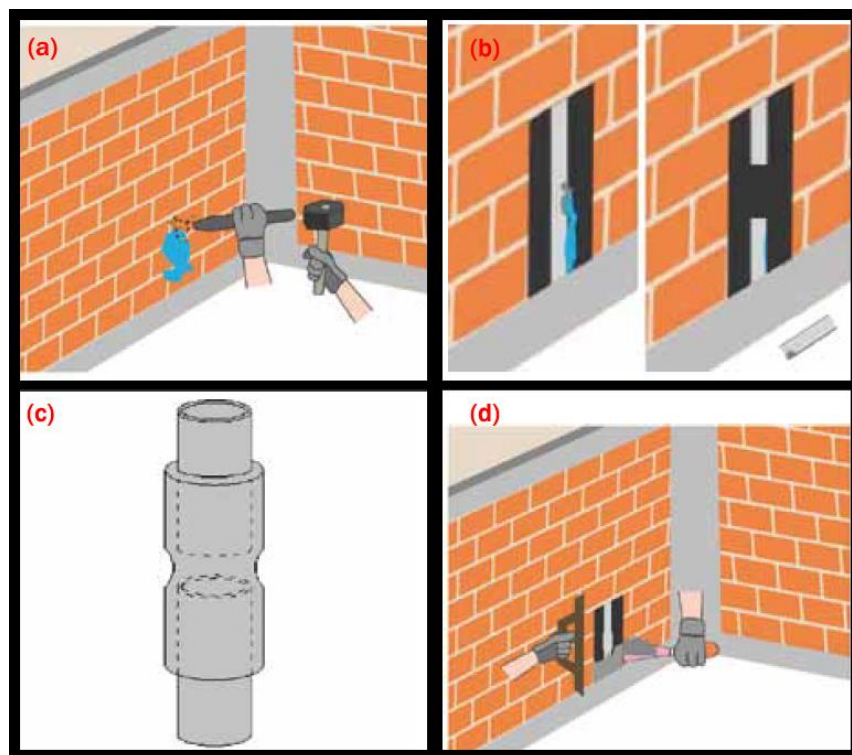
Procedimiento de intervención ante una tubería que ha colapsado generando filtración (a) picado del elemento estructural, en este caso un muro portante, (b) extracción de la tubería y/o accesorios comprometidos, (c) procedimiento de refacción mediante empalme, también el reemplazo es aceptable, (d) resane del elemento estructural
